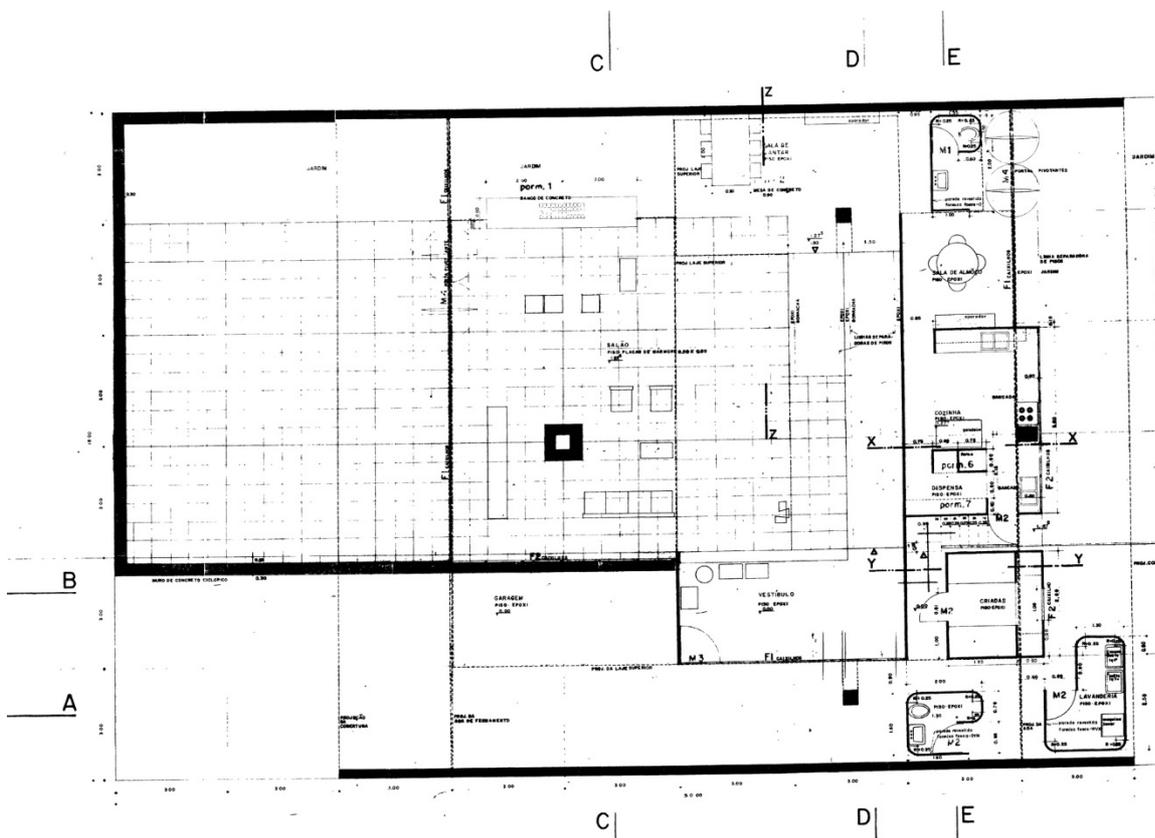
Projeto executivo – planta pavimento térreo – Fonte: Biblioteca FAUUSP
